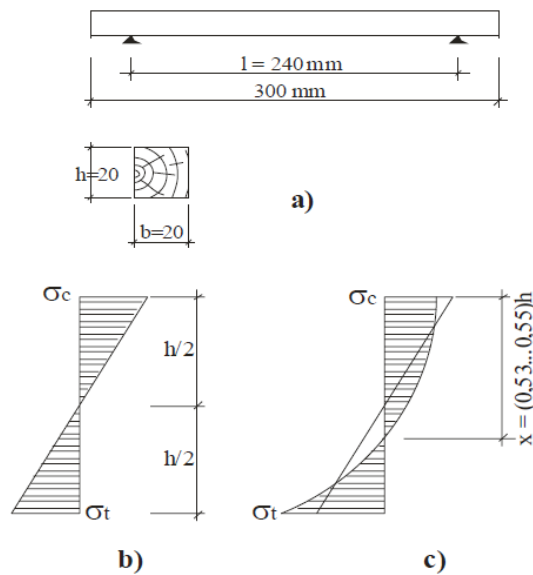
Determinarea rezistenței la încovoiere
